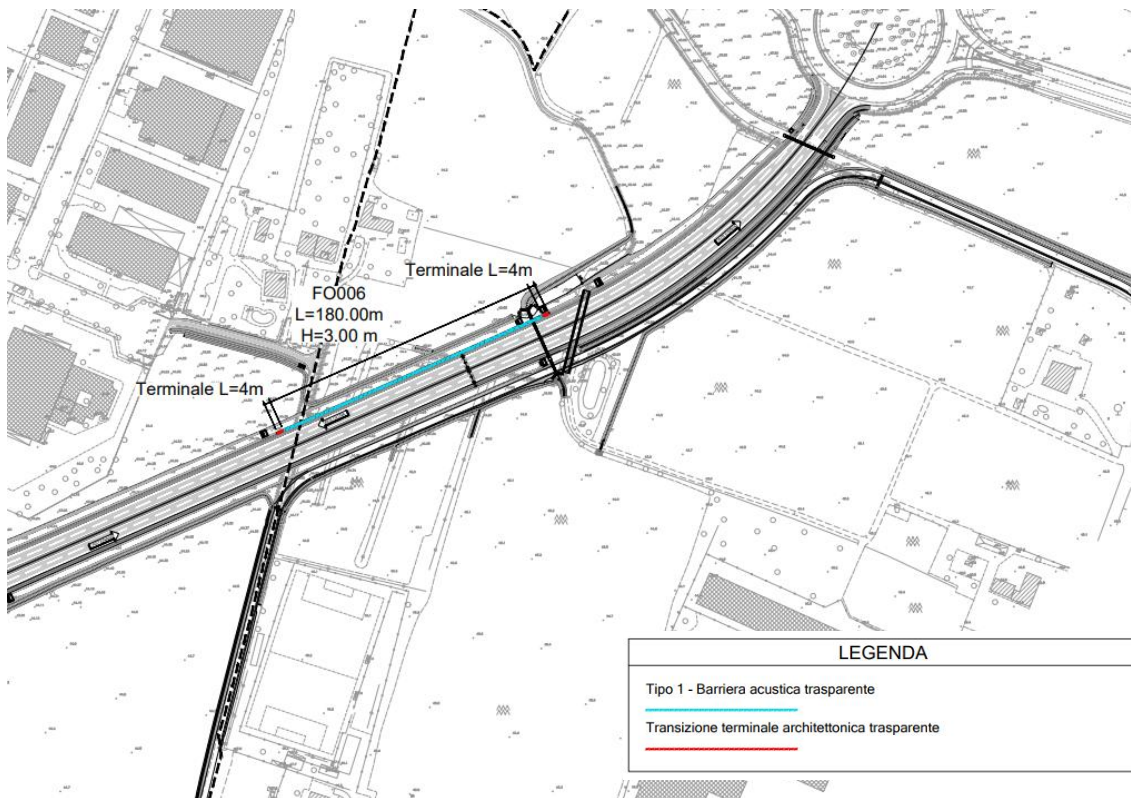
FO006 Planimetria barriera acustica – Intervento viabilistico Lungo Savena
